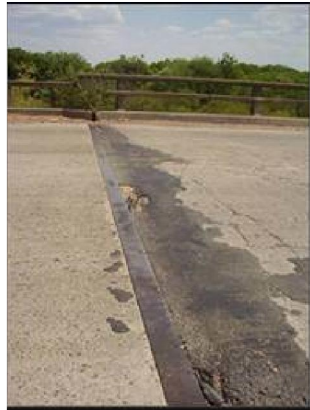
Detalle del estado de las juntas entre losa de aproximación y tablero.
